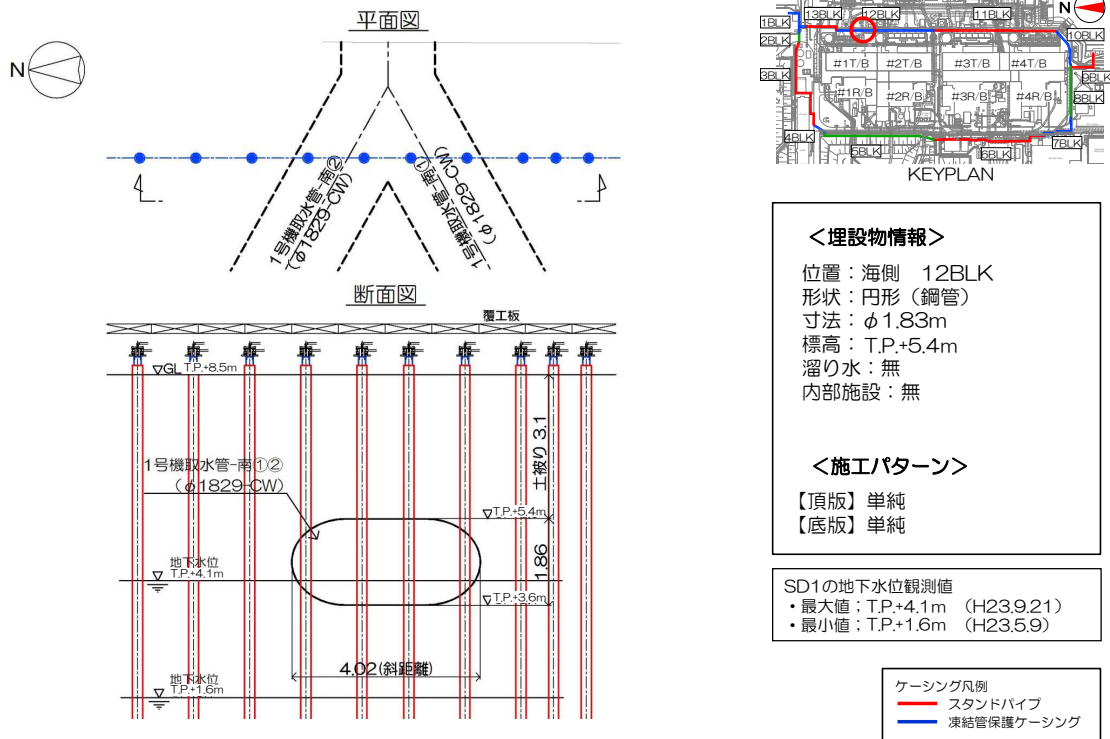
【12-8】1号機取水 pipe-南①② 施工方法（貫通施工）
